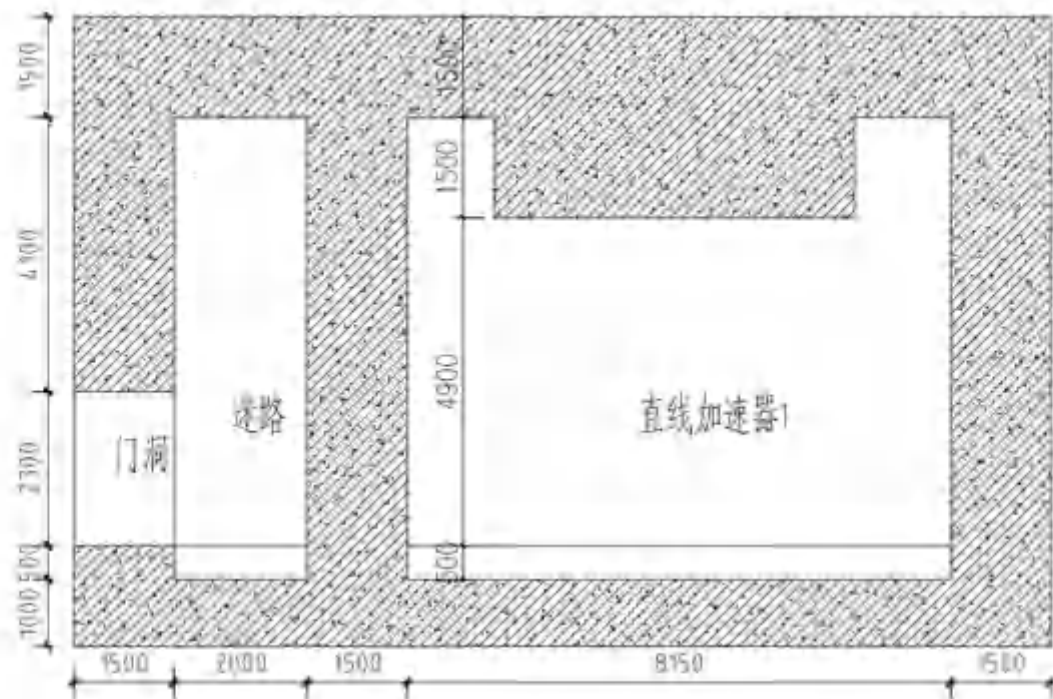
本项目直线加速器机房南北剖面图 (单位: mm)
